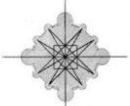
Grundriss eines Pfeilers der Südwesttür.
